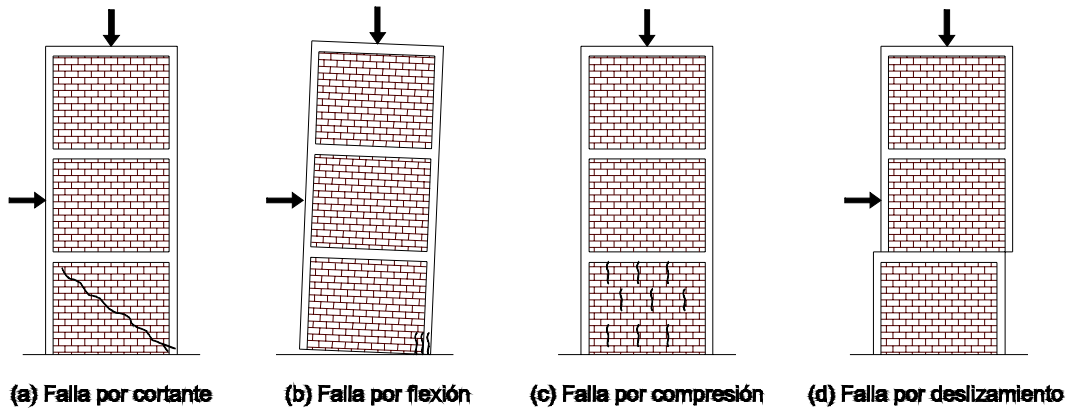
Modos de falla de la mampostería confinada (Drysdale, Hamid, & Baker, 1994).
